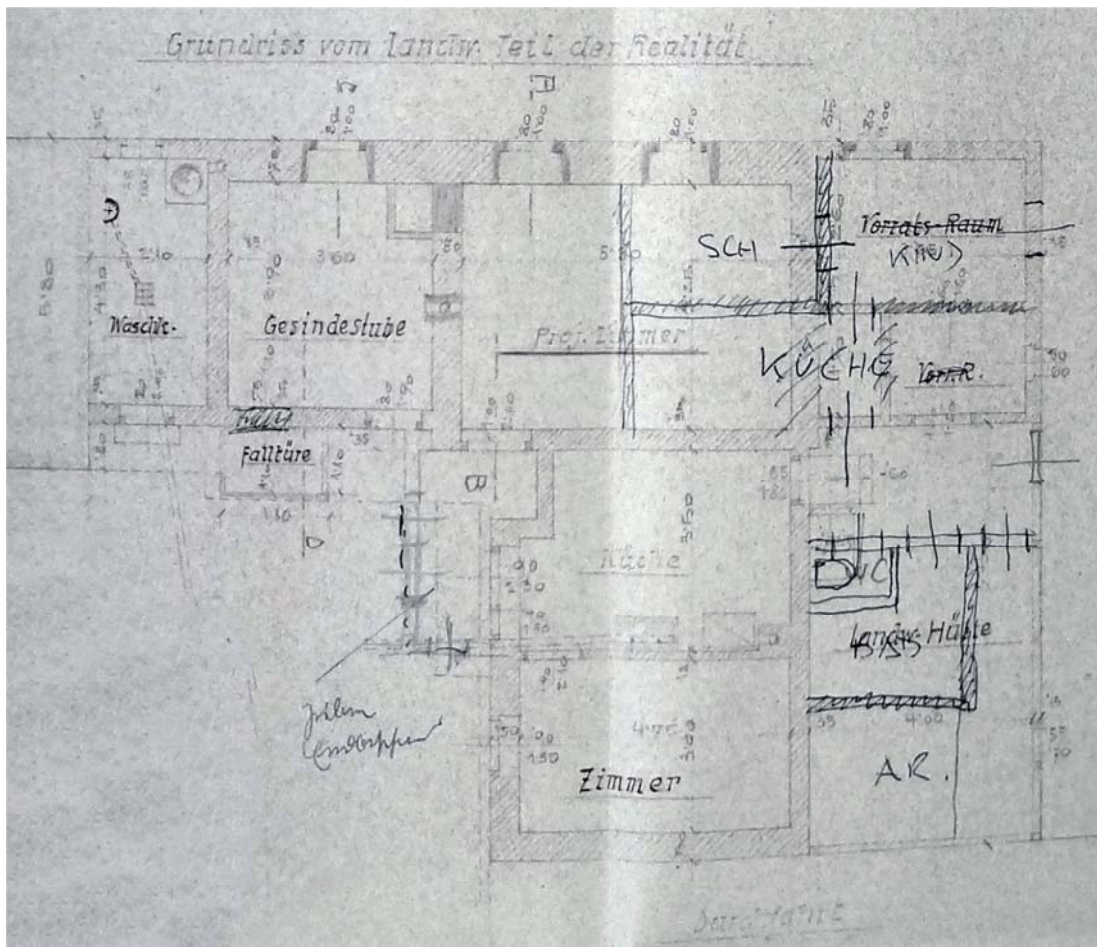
Grundriss vom landwirtschaftlichen Teil mit Überlagerung diverser, später vorgenommener Grundrissänderungen
